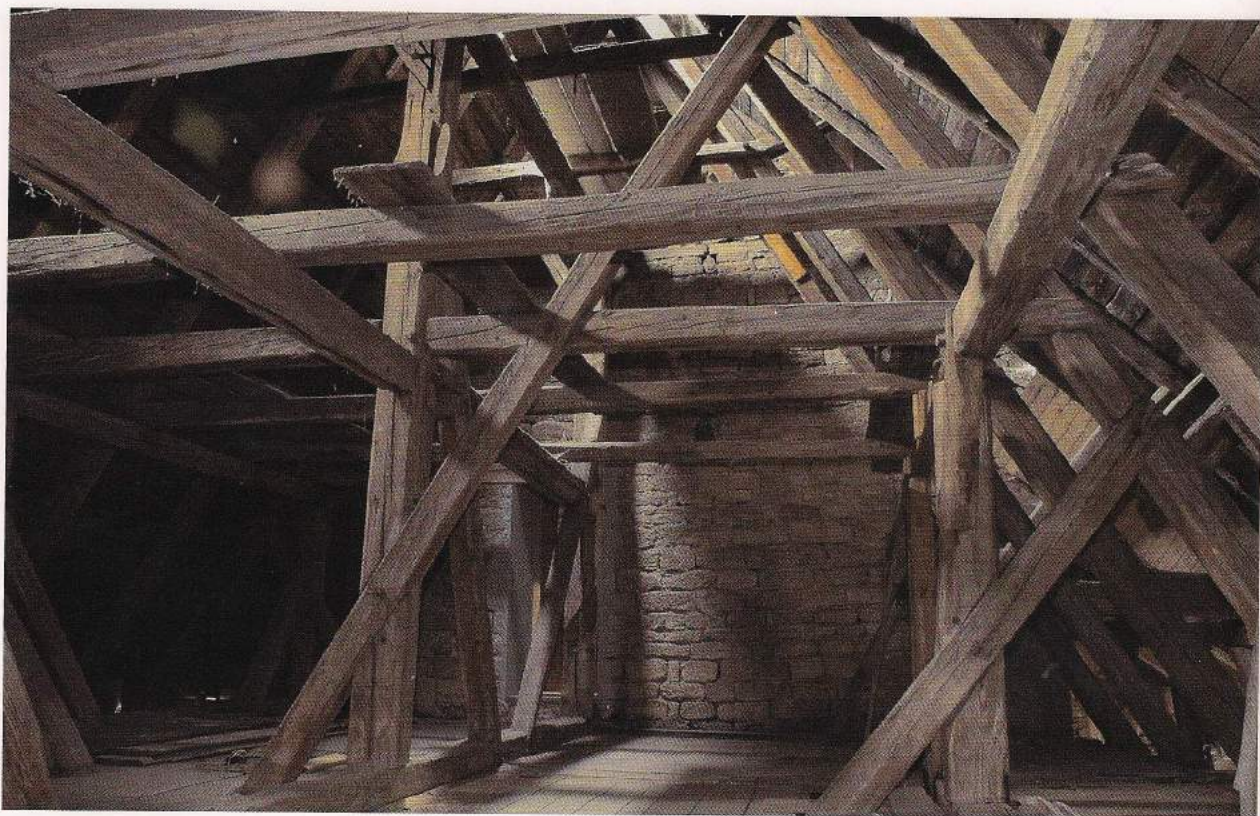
Wünschendorf, Kirche St. Veit, das Dachwerk über dem Kirchensaal wurde über einer dreifach stehenden Dachstuhlkonstruktion aufgeschlagen und datiert 1475 (d).
